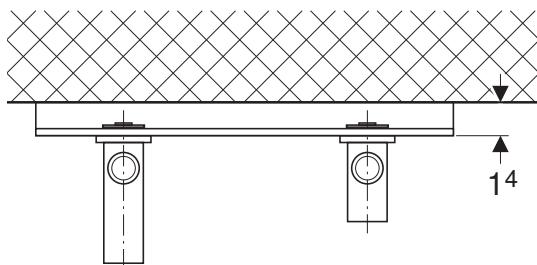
Монтажные размеры для наружного монтажа с использованием прямой монтажной панели Geberit
